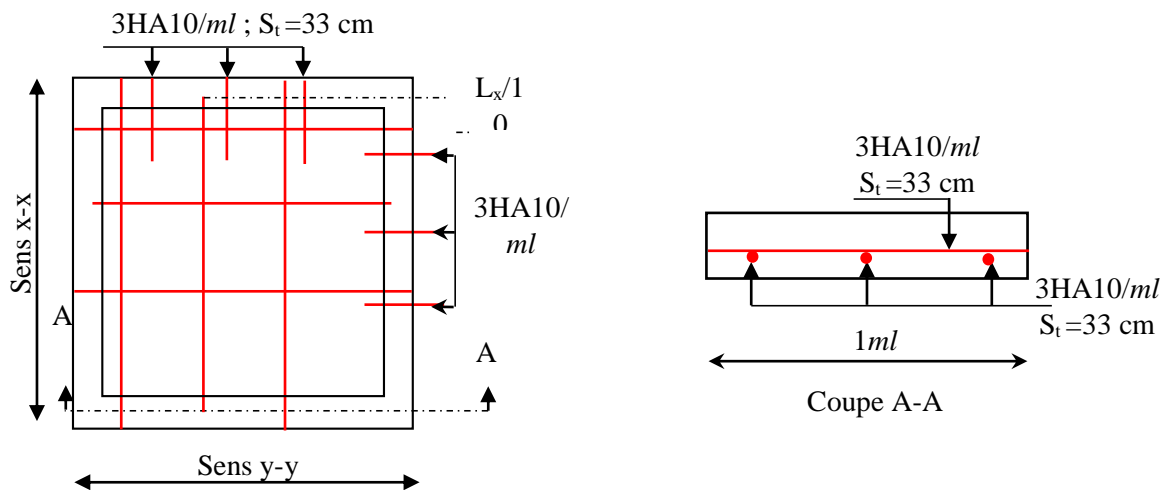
Schéma de ferrailage la dalle pleine au-dessous de l'ascenseur
